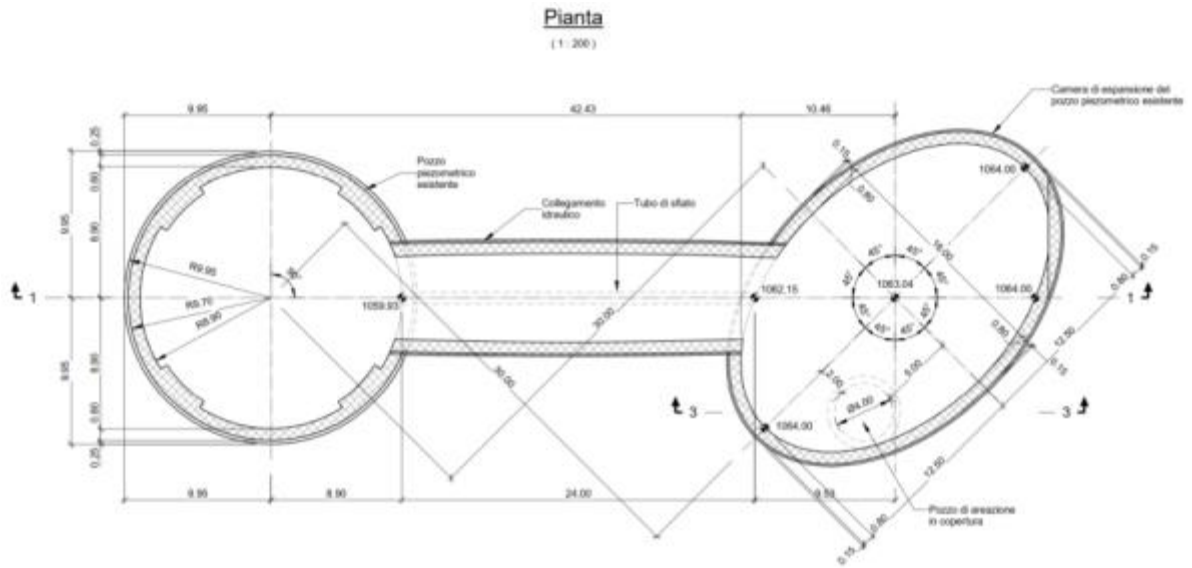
Nuova camera di espansione al pozzo piezometrico sulla derivazione Provvidenza – pianta
